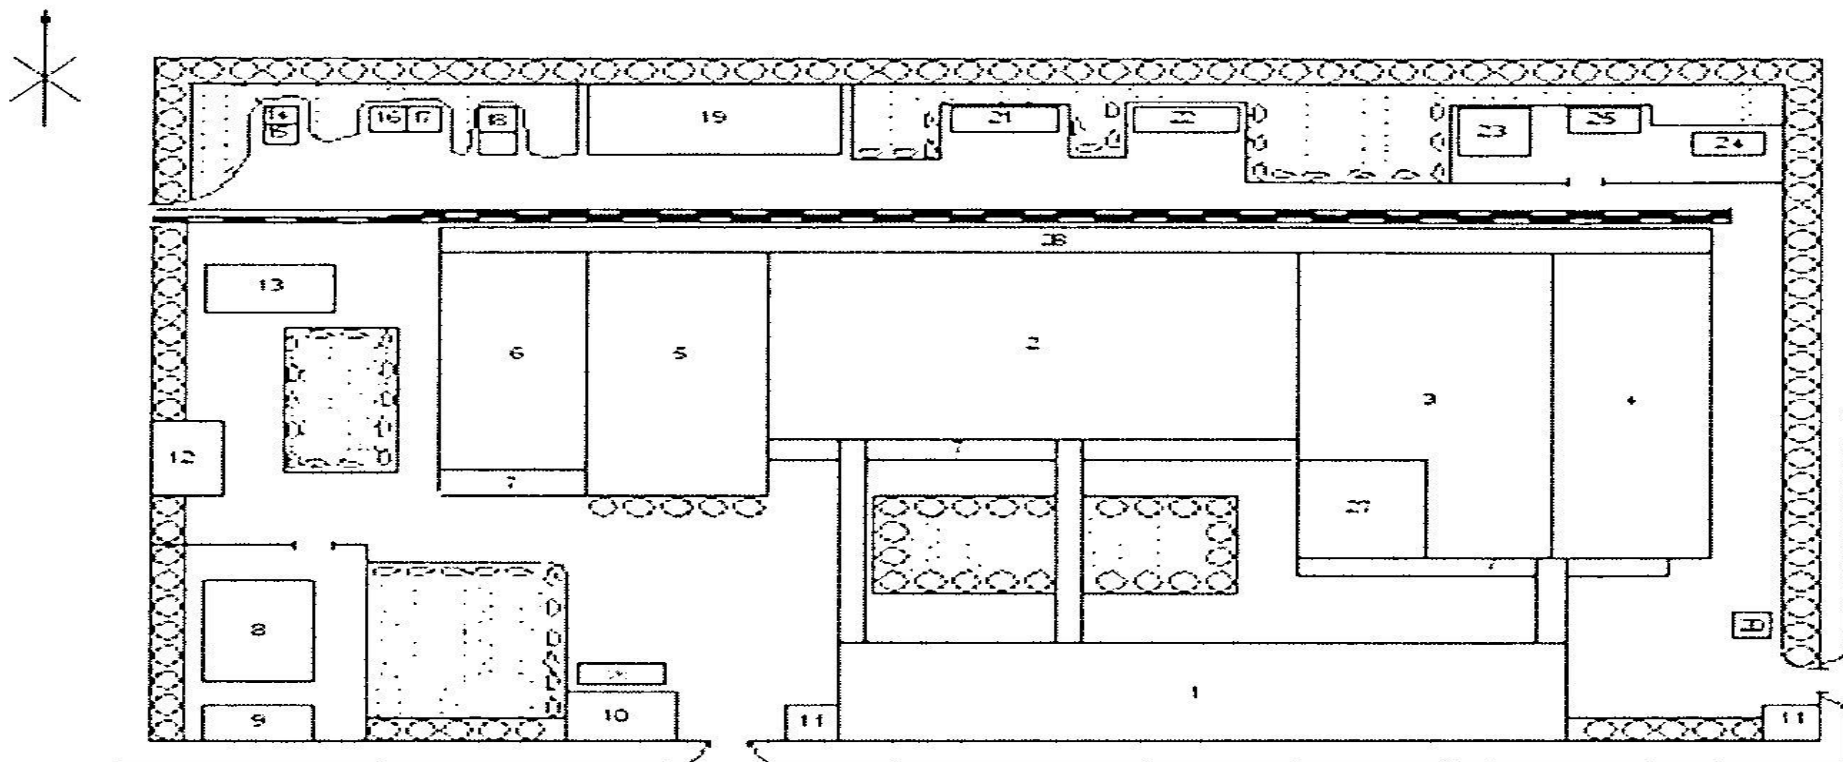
Генеральний план типового м'ясокомбінату (багатоповерховий)
